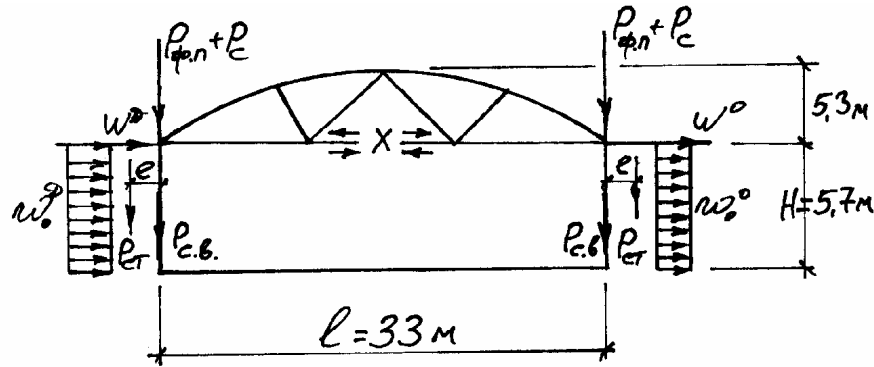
Схема навантажень на поперечну раму будівлі
